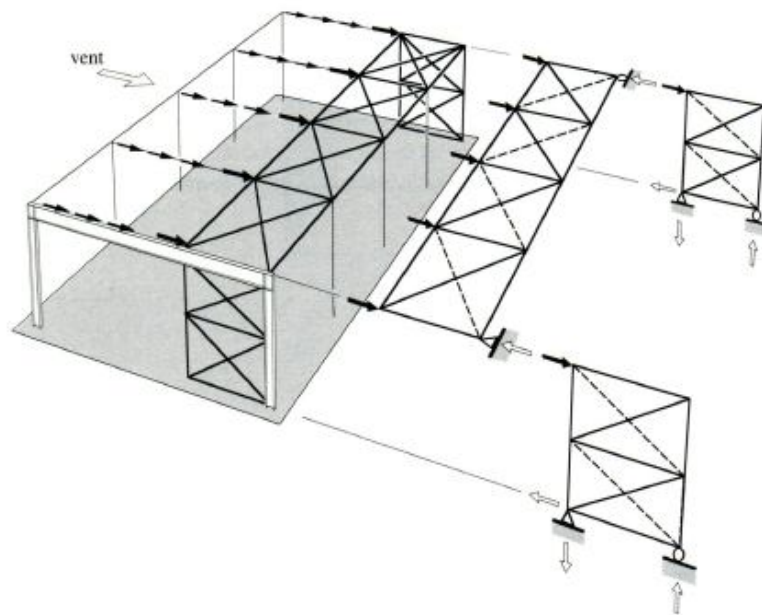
Cheminement des forces transversales dans le cas d'une structure à toiture horizontale.
